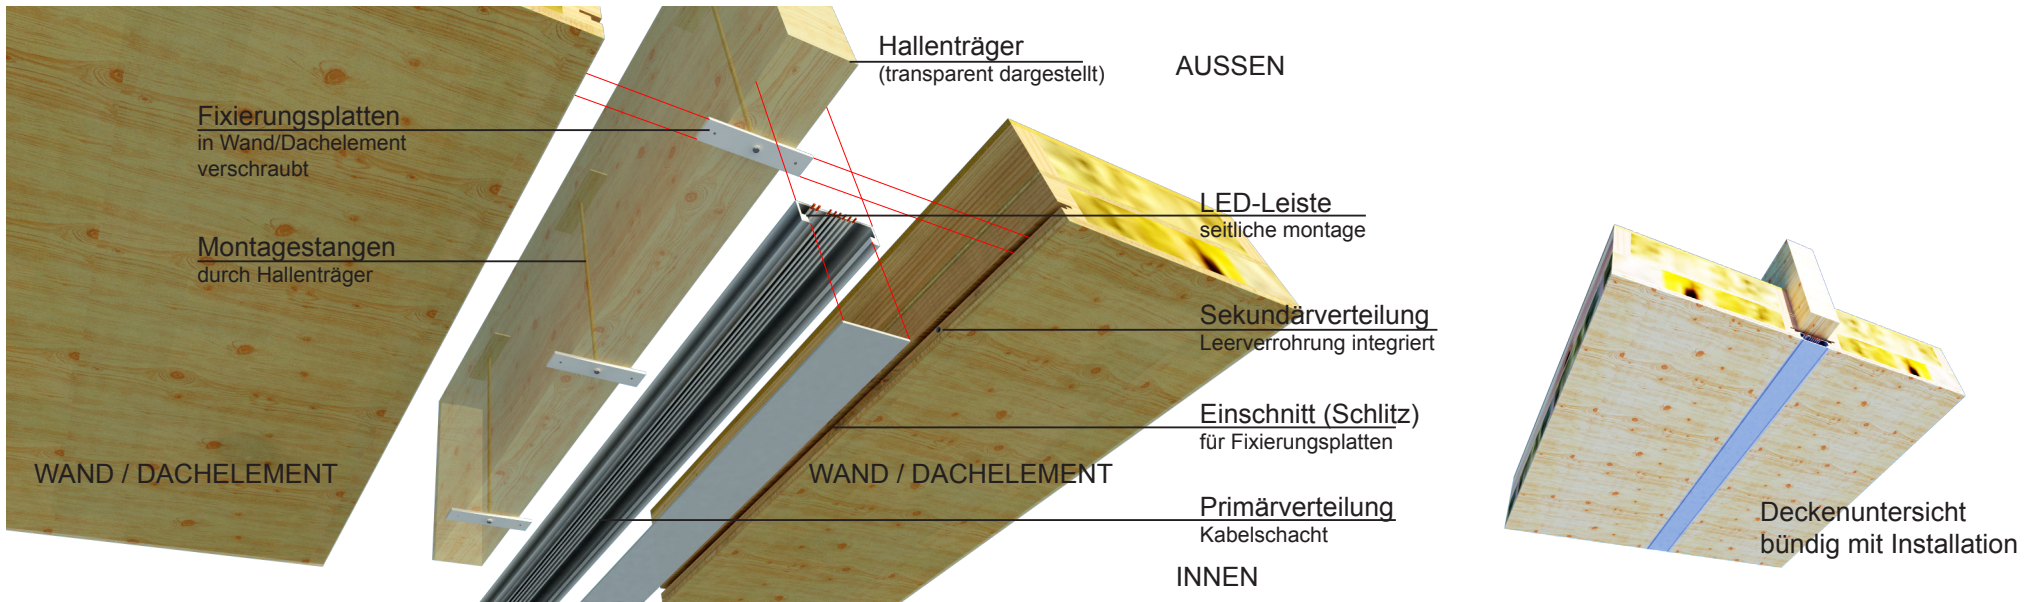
| Ausschnitt Deckenuntersicht Explosionsskizze
